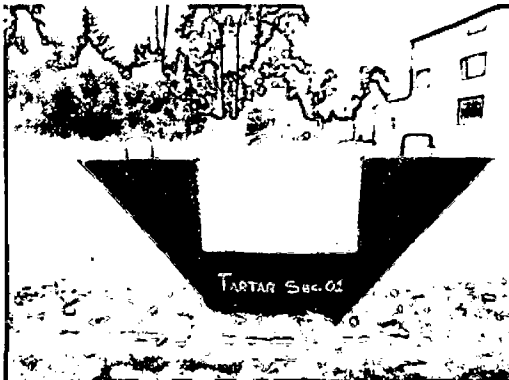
VERTEDERO RECTANGULAR SECCION INICIAL (PROG: 0+000)
